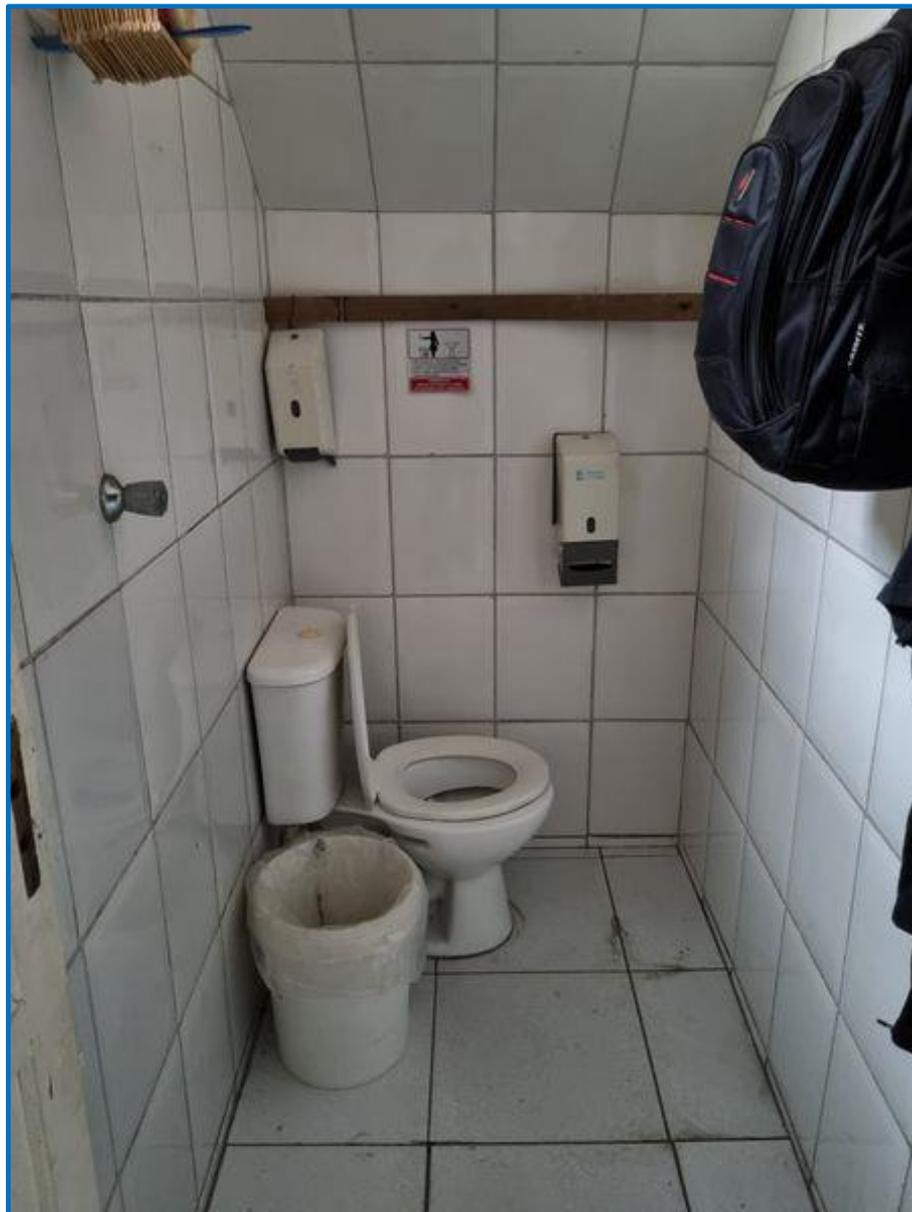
Vista do revestimento de teto do pavimento superior da “Benfeitoria 01 – Edificação Principal (Trecho Comercial)”.
